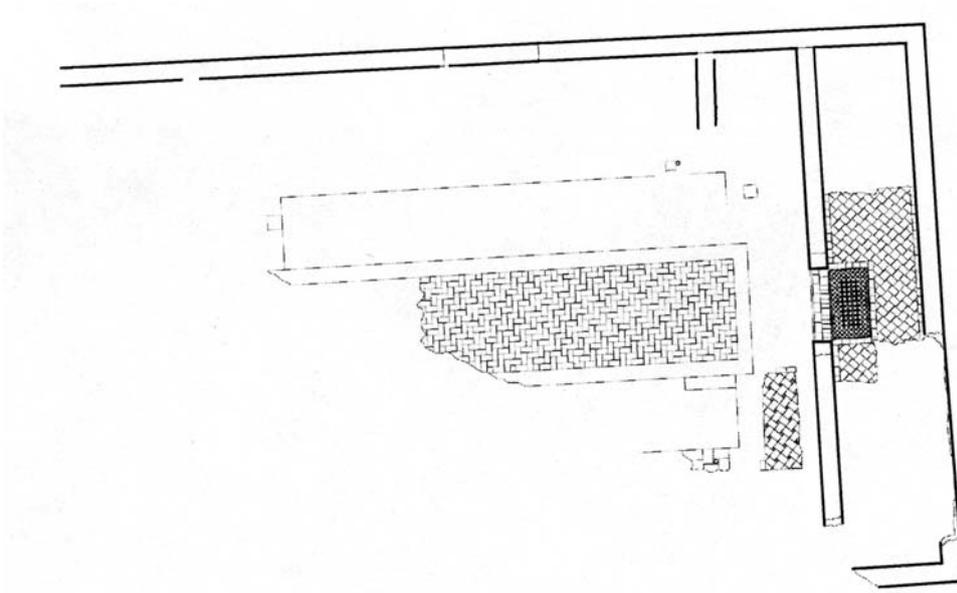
Casa nazarí bajo el jardín de la Calle Real, plano 2.139 del archivo de planos de la Alhambra, 1963.
